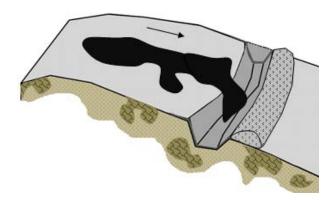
Trinchera de contención impermeabilizada, construida en el recorrido esperado del derrame
